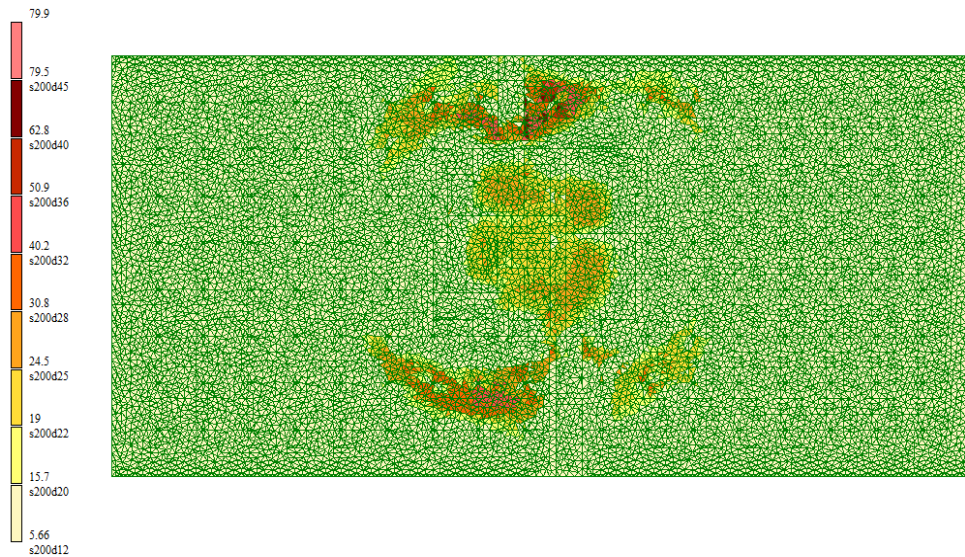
Схема армирования фундаментной плиты по оси Y (у верхней грани)
